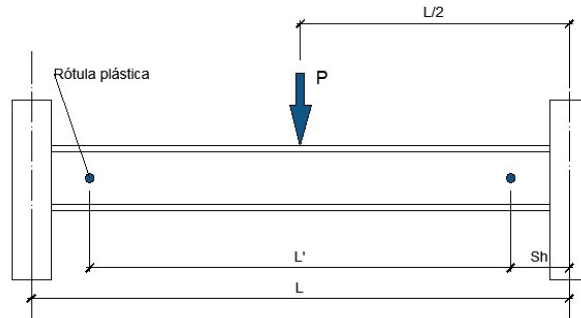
8-Ubicación de rótulas plásticas en vigas [19].
